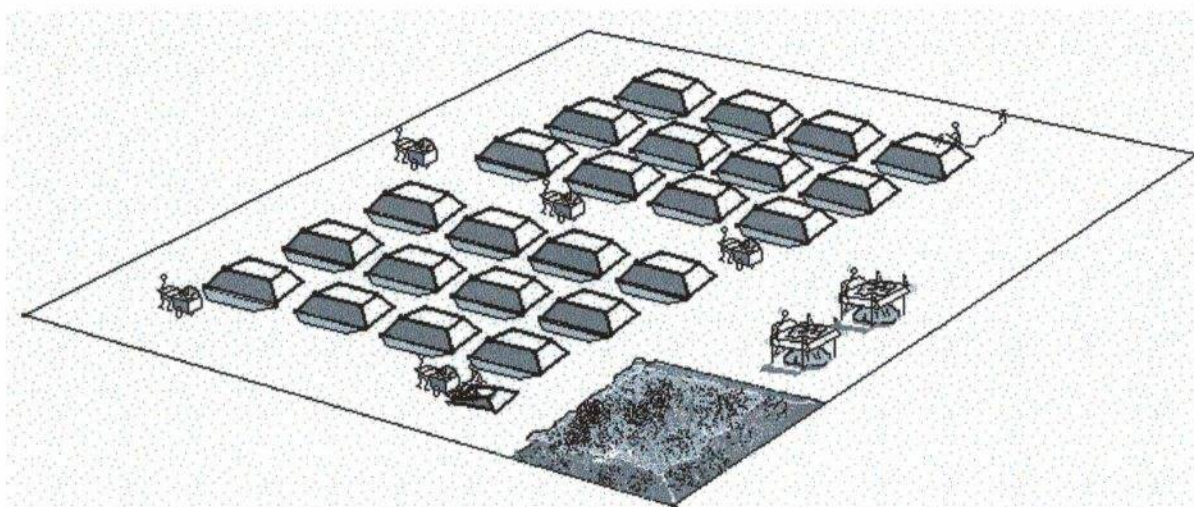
Primeira concepção construtiva do módulo COMPOSTAGEM – CROQUI.
